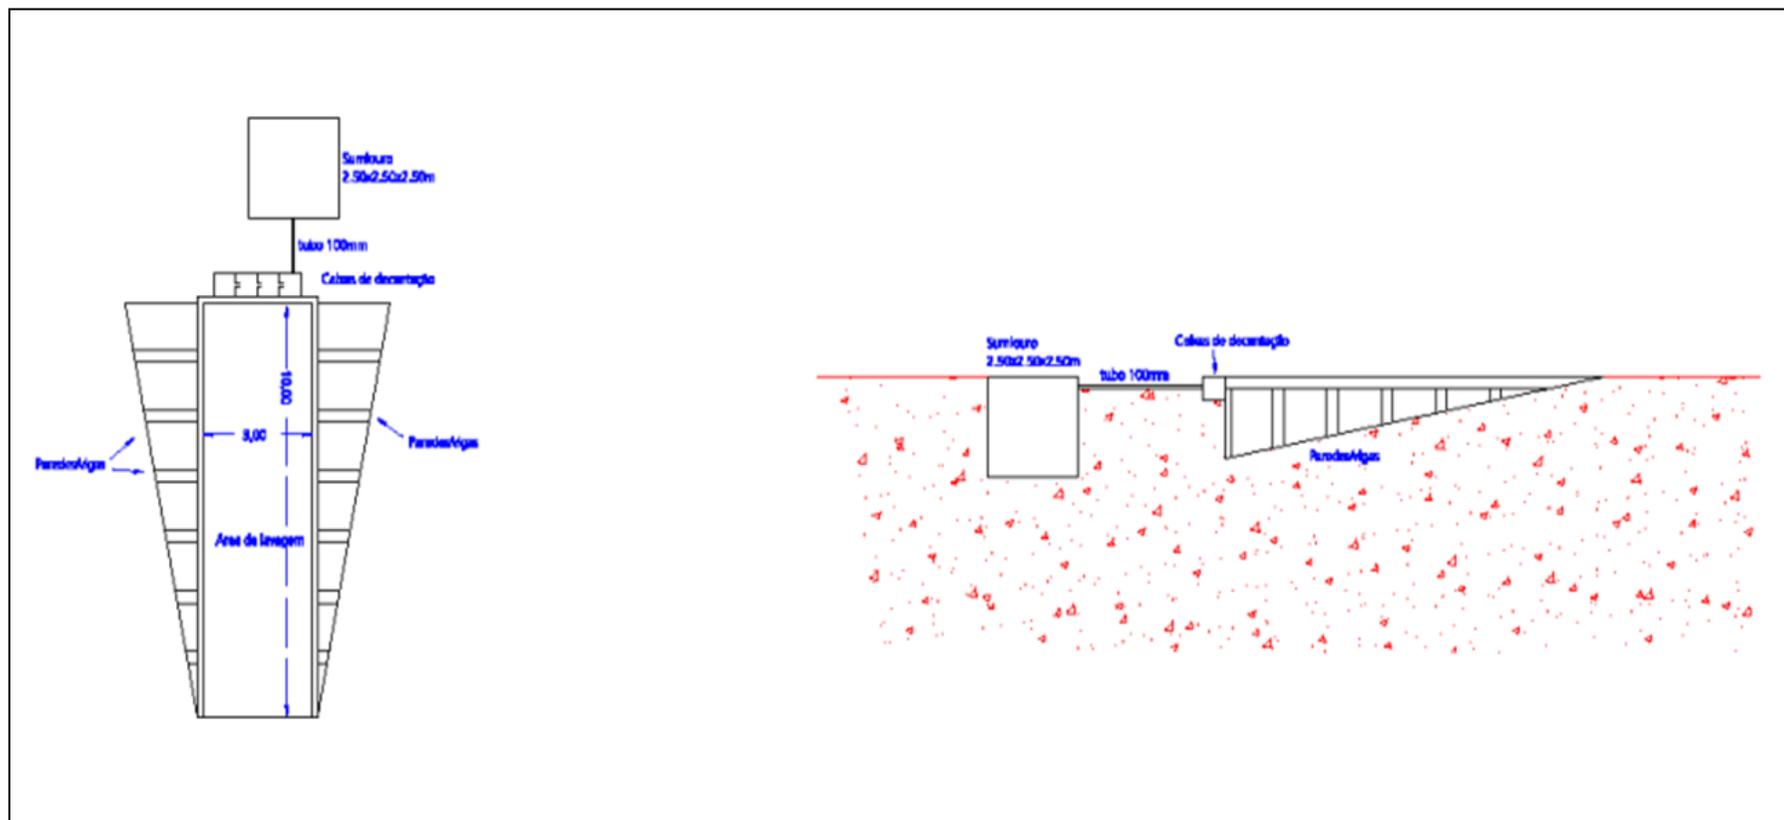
Sistema de separação de resíduos na lavagem do caminhão betoneira
